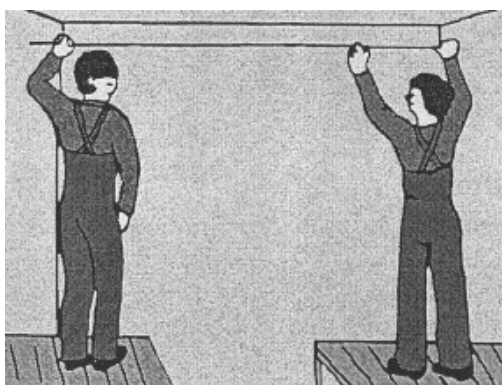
Разметка линии верха полотнищ виниловых обоев
